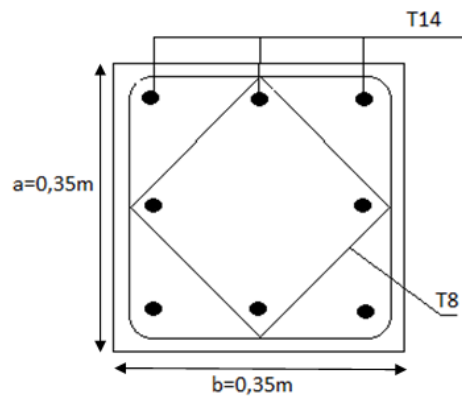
Disposition générale des armatures sur les poteaux.
